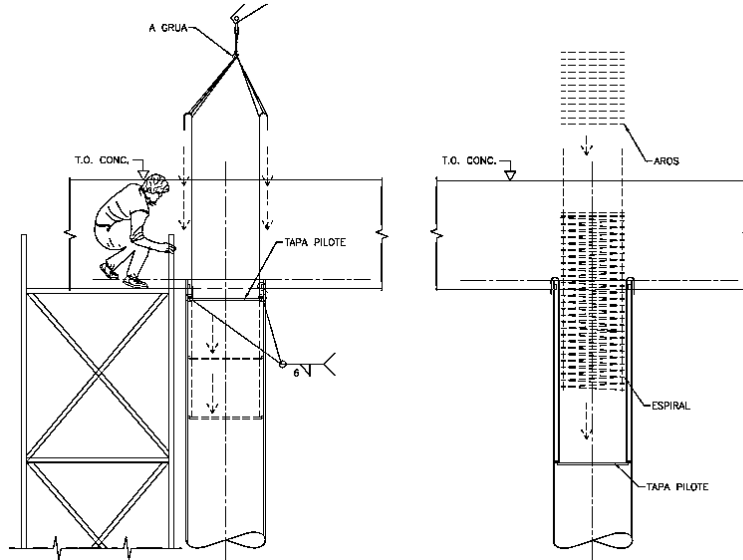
Instalación del Refuerzo dentro del pilote
